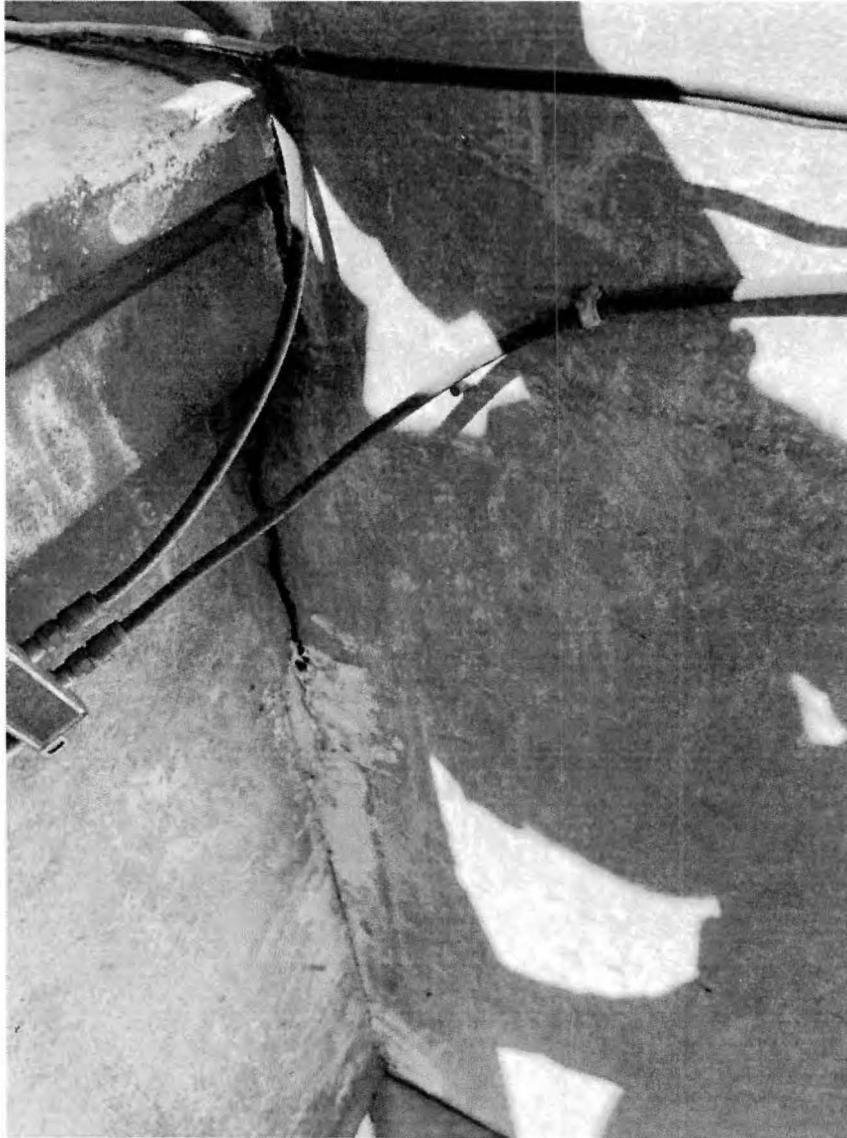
Fisura en muro de balcón de depto 952G.
